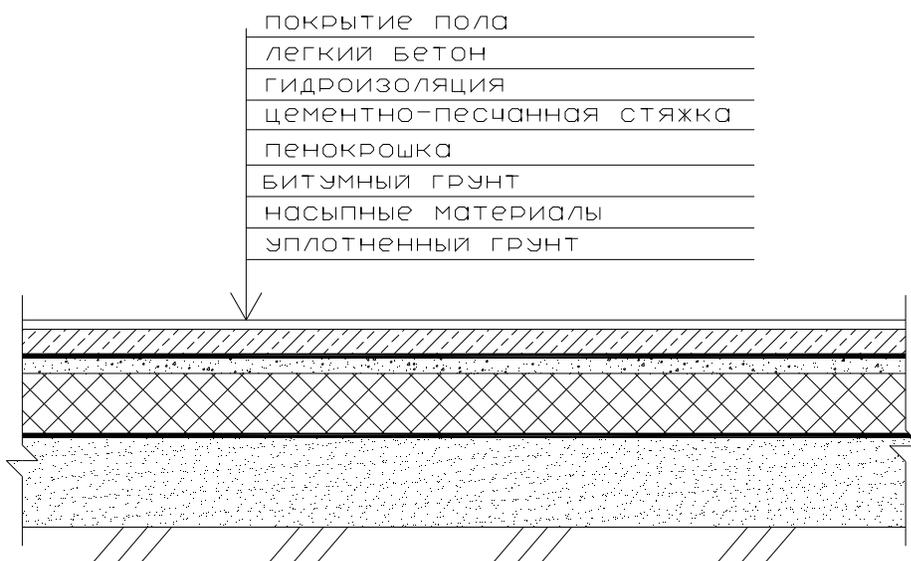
Тепловая изоляция пола из пенокрошки по грунту
